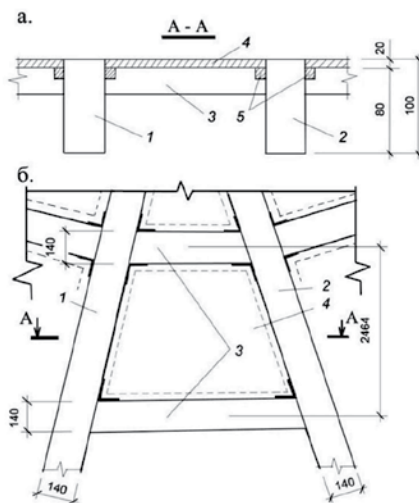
Схема опирания плит на каркас купола: а – разрез; б – план
